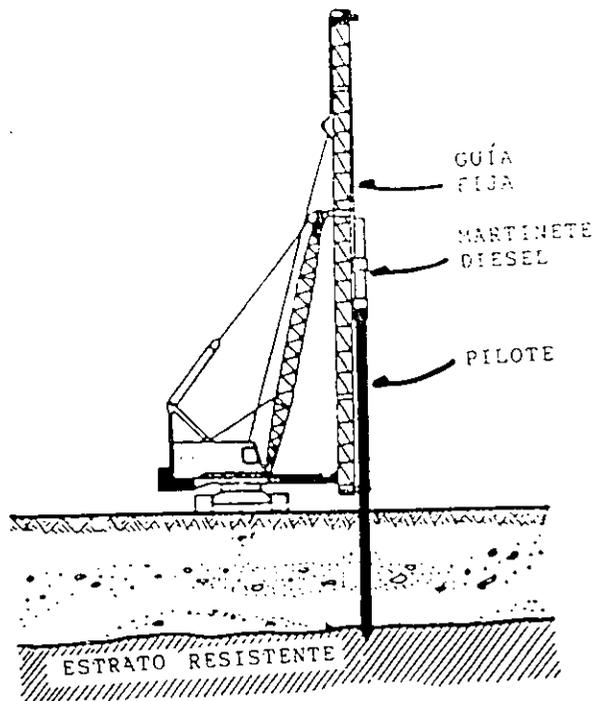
PILOTE HINCADO VERTICAL.
